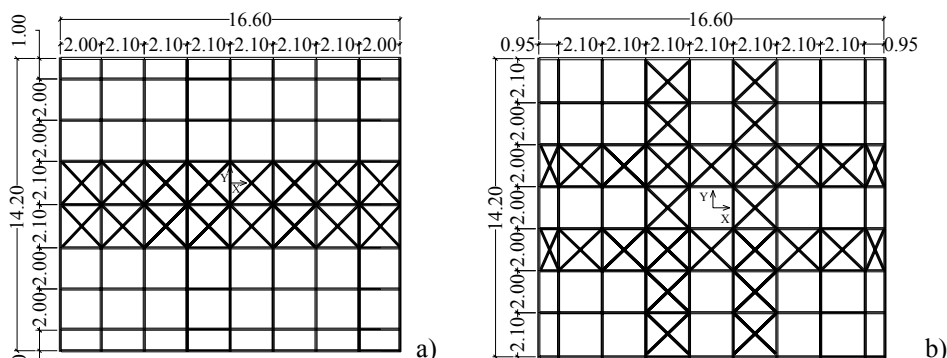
a) Pianta del grigliato superiore; b) Pianta del grigliato inferiore; c) Carpenteria solaio; d) Particolare appoggio; e) Sezione A-A; f) Vista 3D. (continua)
